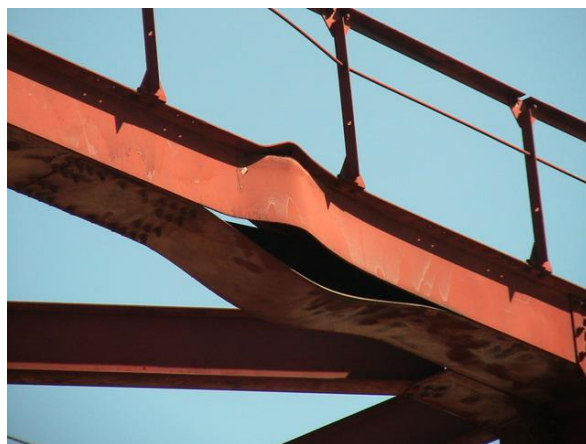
Разрыв сварных швов верхнего пояса фермы [16]
